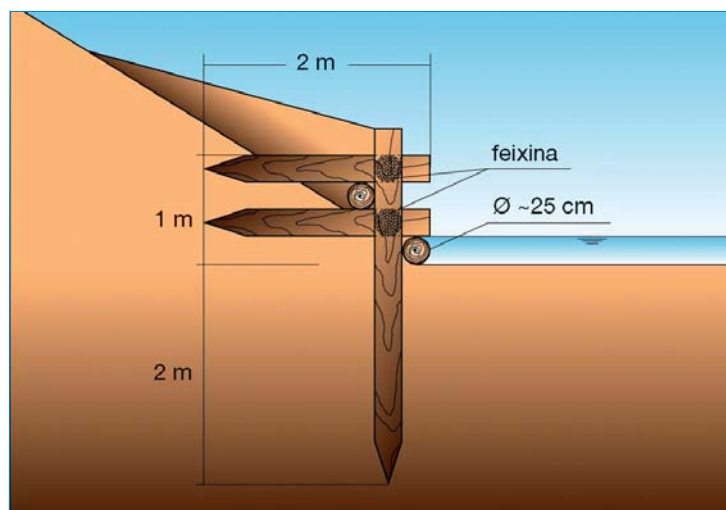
Entramat viu amb pal vertical (MIXT-4).
